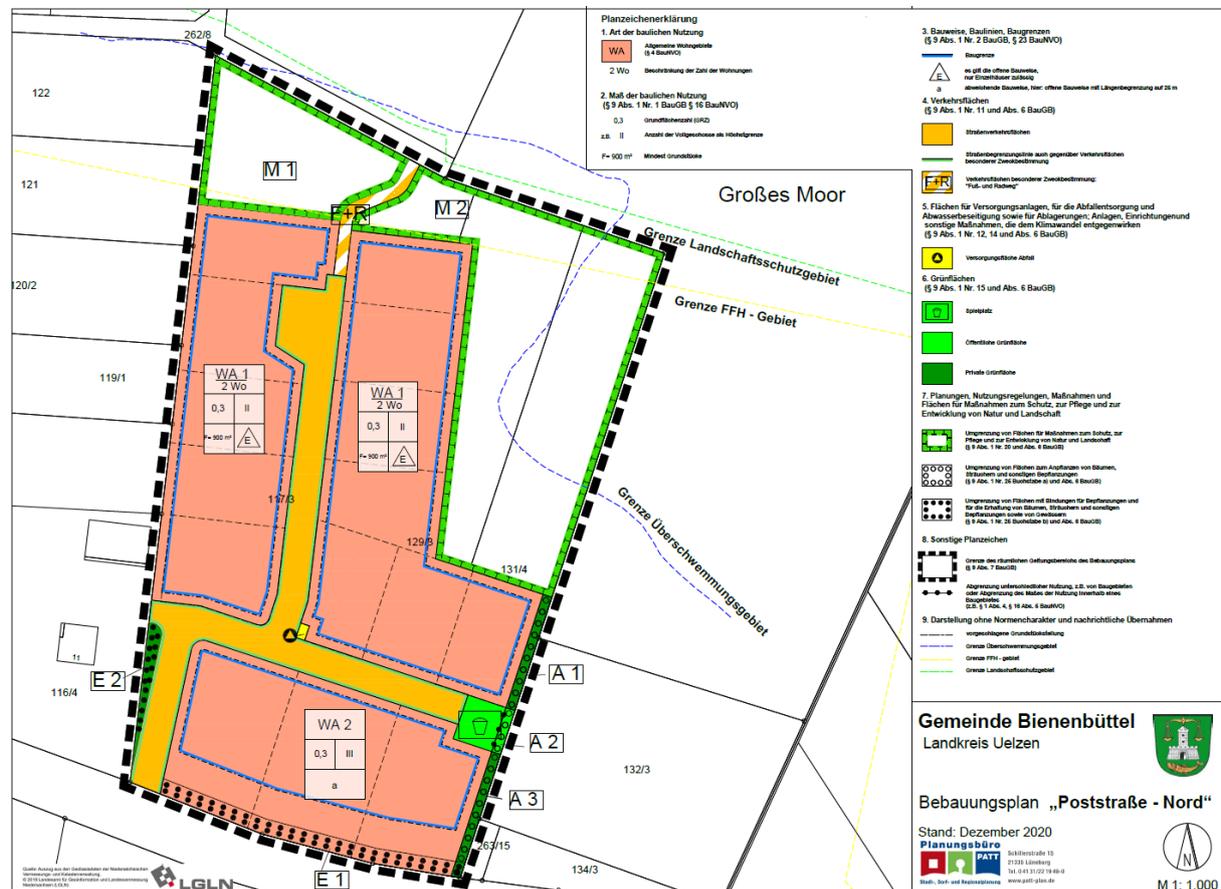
Bebauungsplan, Stand: Entwurf, Quelle: Planungsbüro Patt
